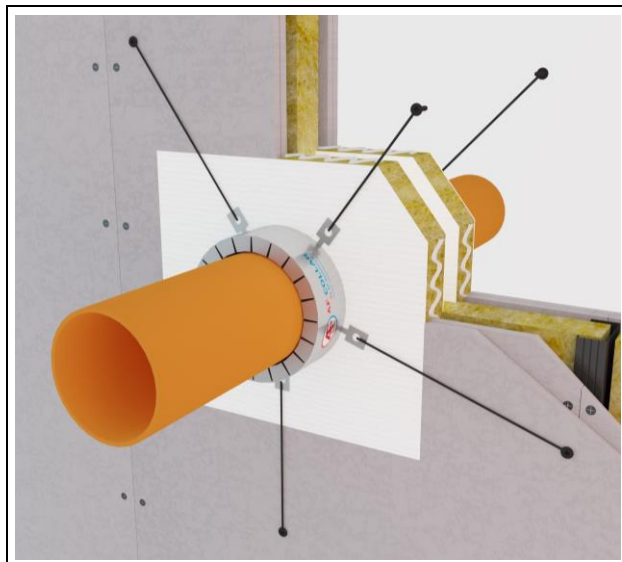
Esempio di un KF-Collar fissato con cavi d'acciaio ad una parete.
